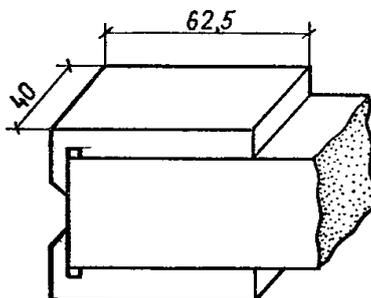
Підготовка зразка для випробування на стиск
